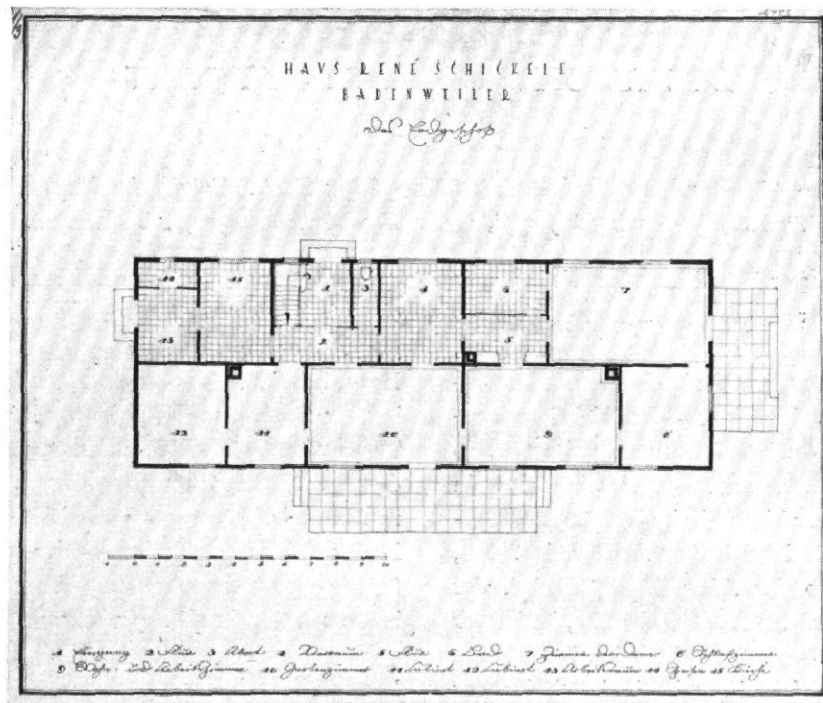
| Haus René Schickele, Badenweiler | Grundriß des Erdgeschosses, Maßstab 1 : 300
